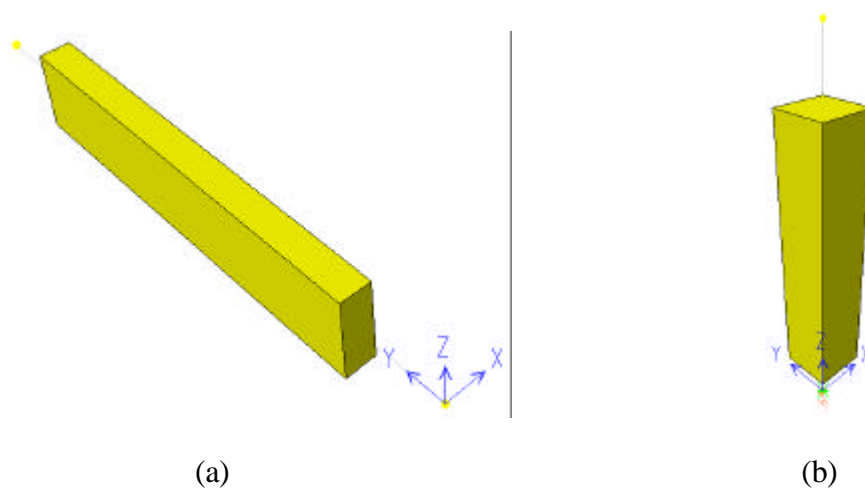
Elementos de barras, (a) vigas e (b) pilar.
